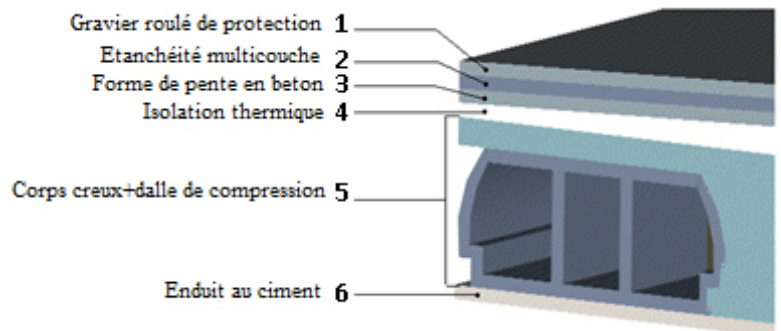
Disposition des matériaux pour Plancher à corps creux de la toiture.
